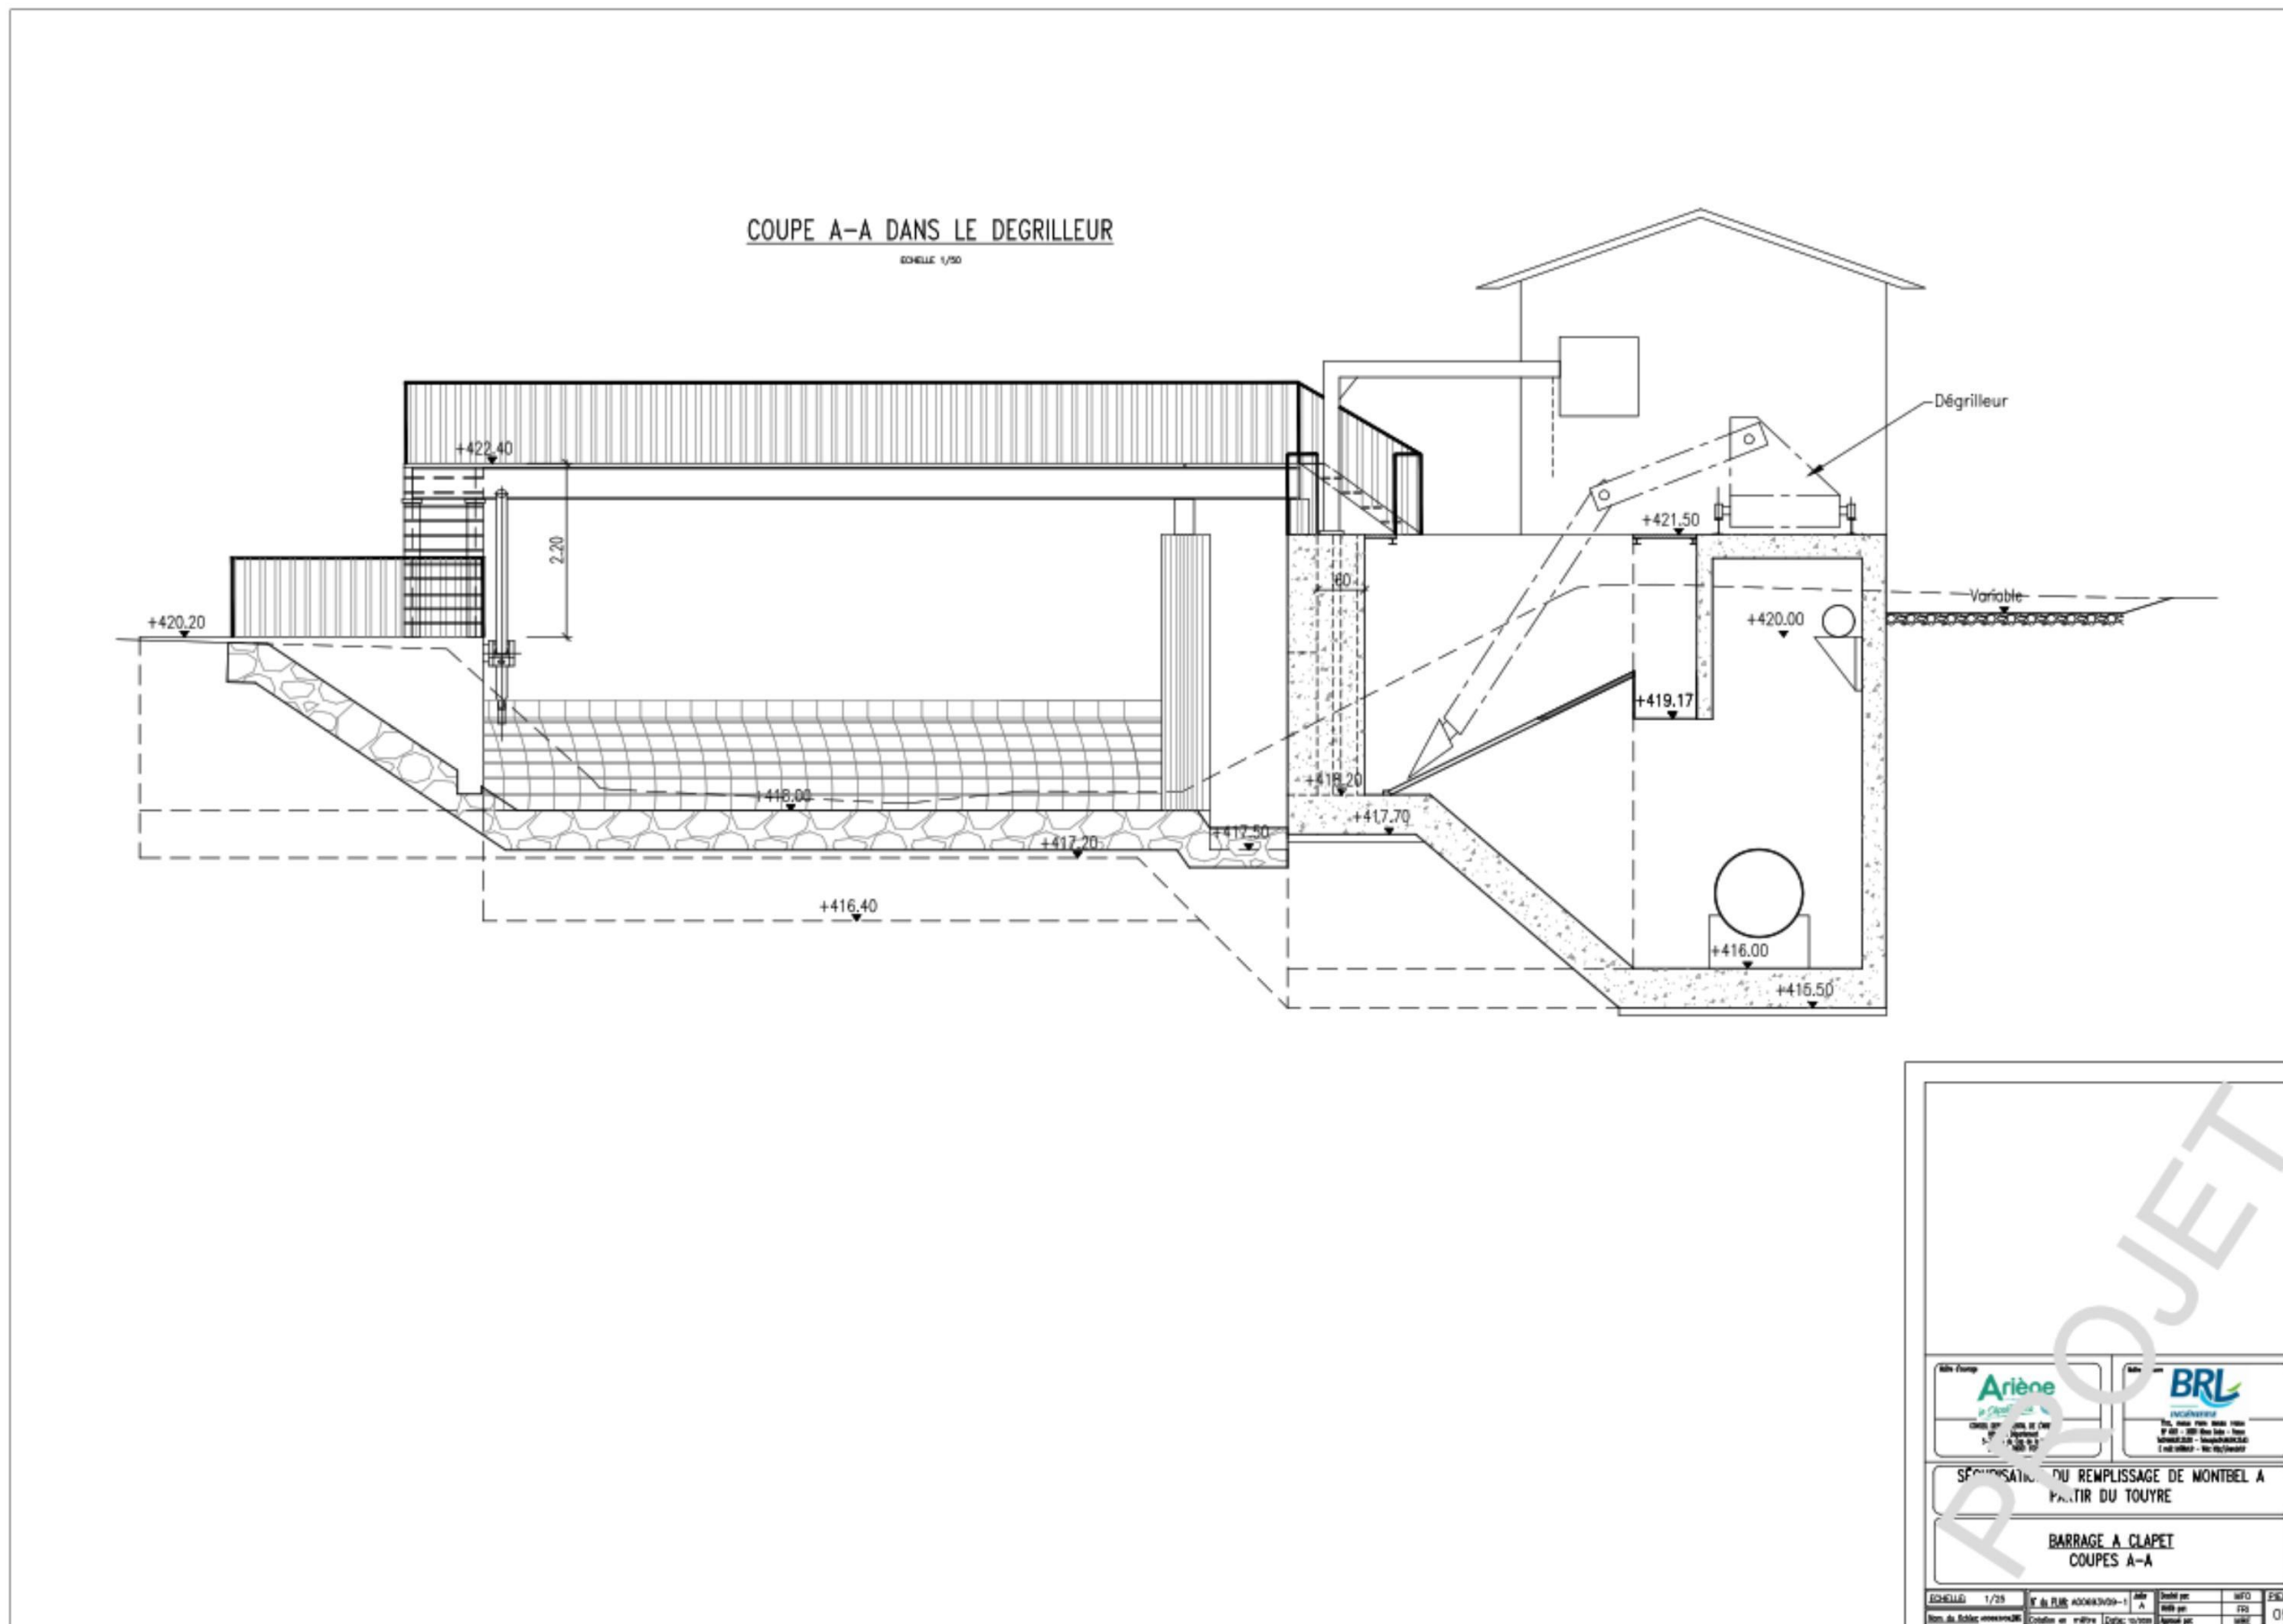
Barrage à clapet – Coupes PT et LT (PRO)
